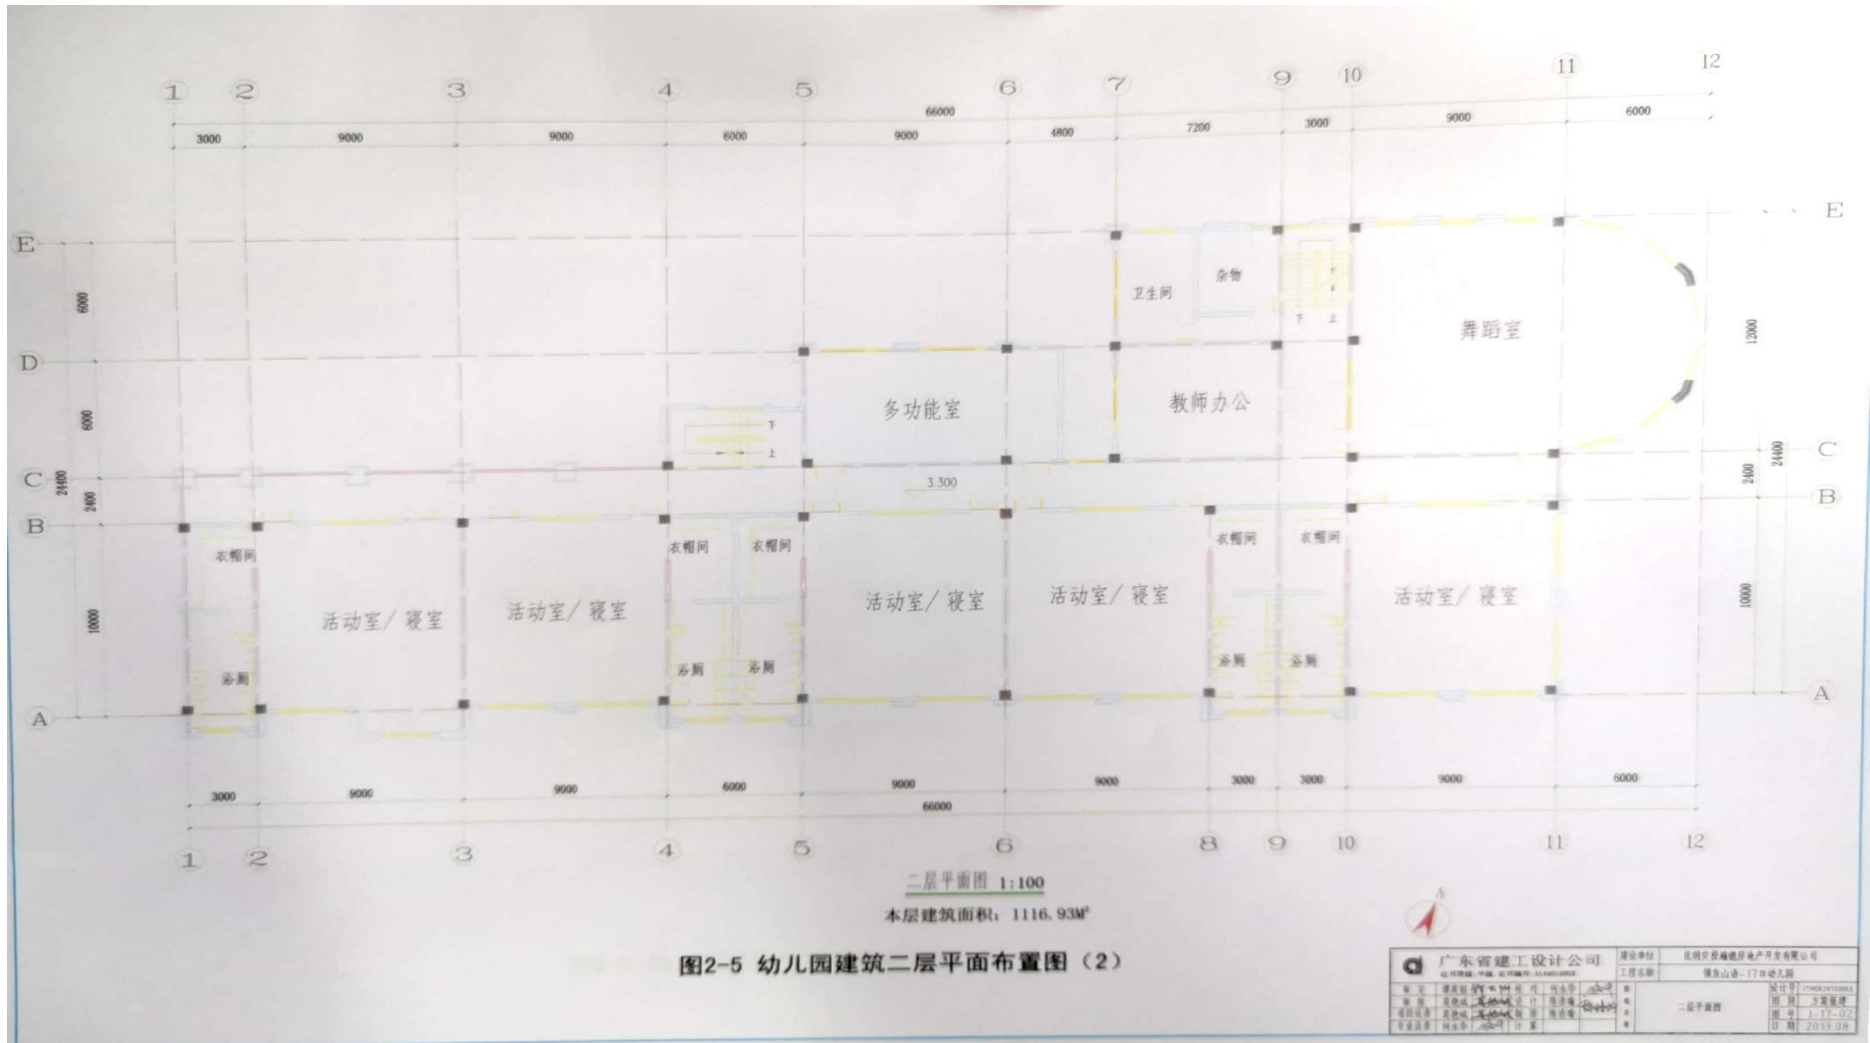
项目 A2 地块幼儿园地上二层平面布置图
